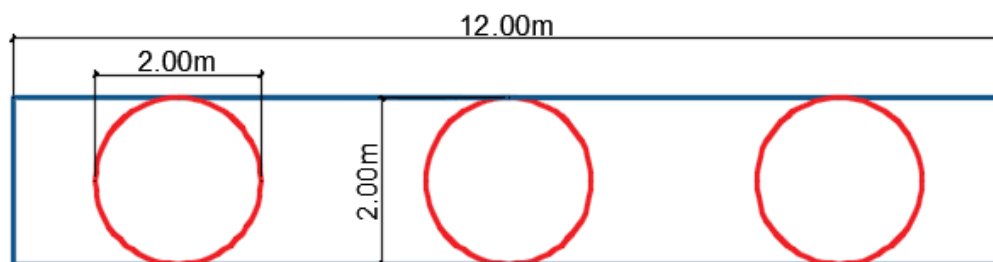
Sección típica de Pilares (Fuente: elaboración propia)
